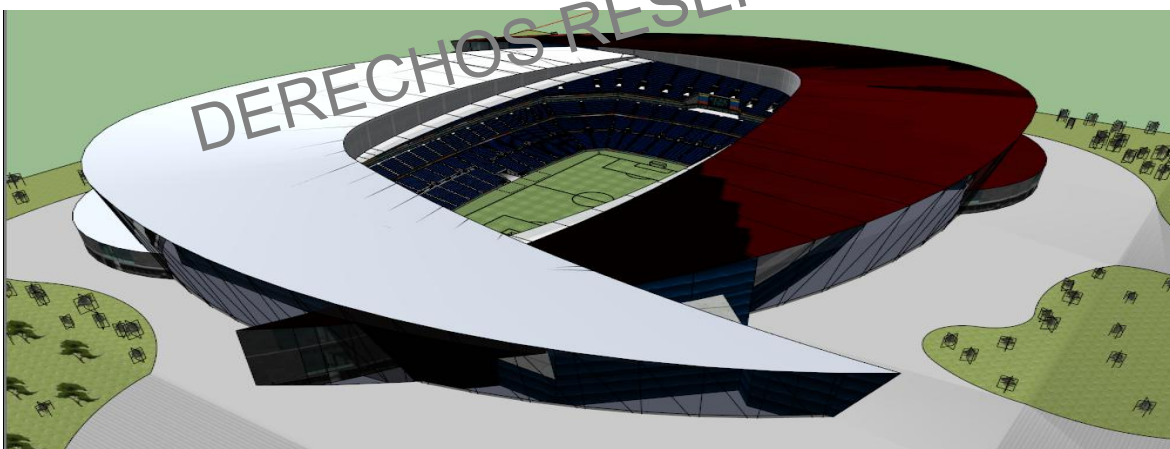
Imagen referencial de Estadio Plan Maestro. Fuente: Elaboración Propia (2014)
